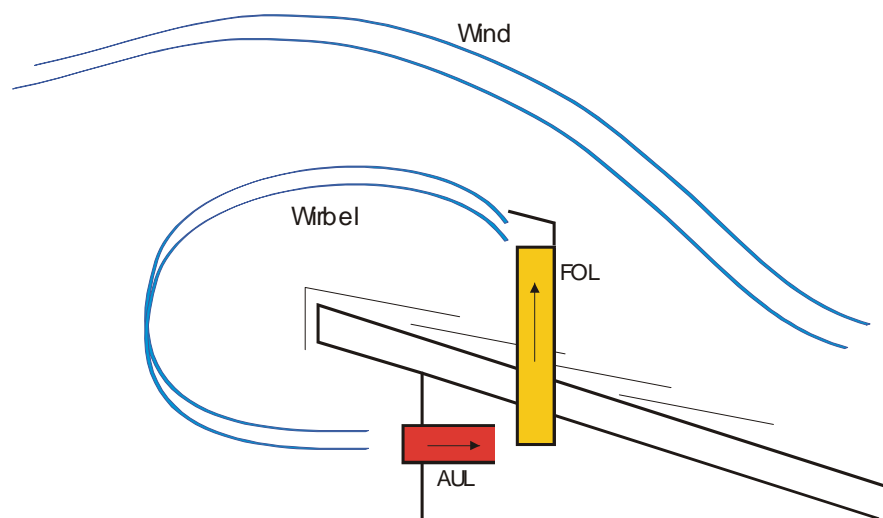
Situation der Aussenluftfassung und des Fortluftausblasstelle im Dachschnitt des Gebäudes D dargestellt
